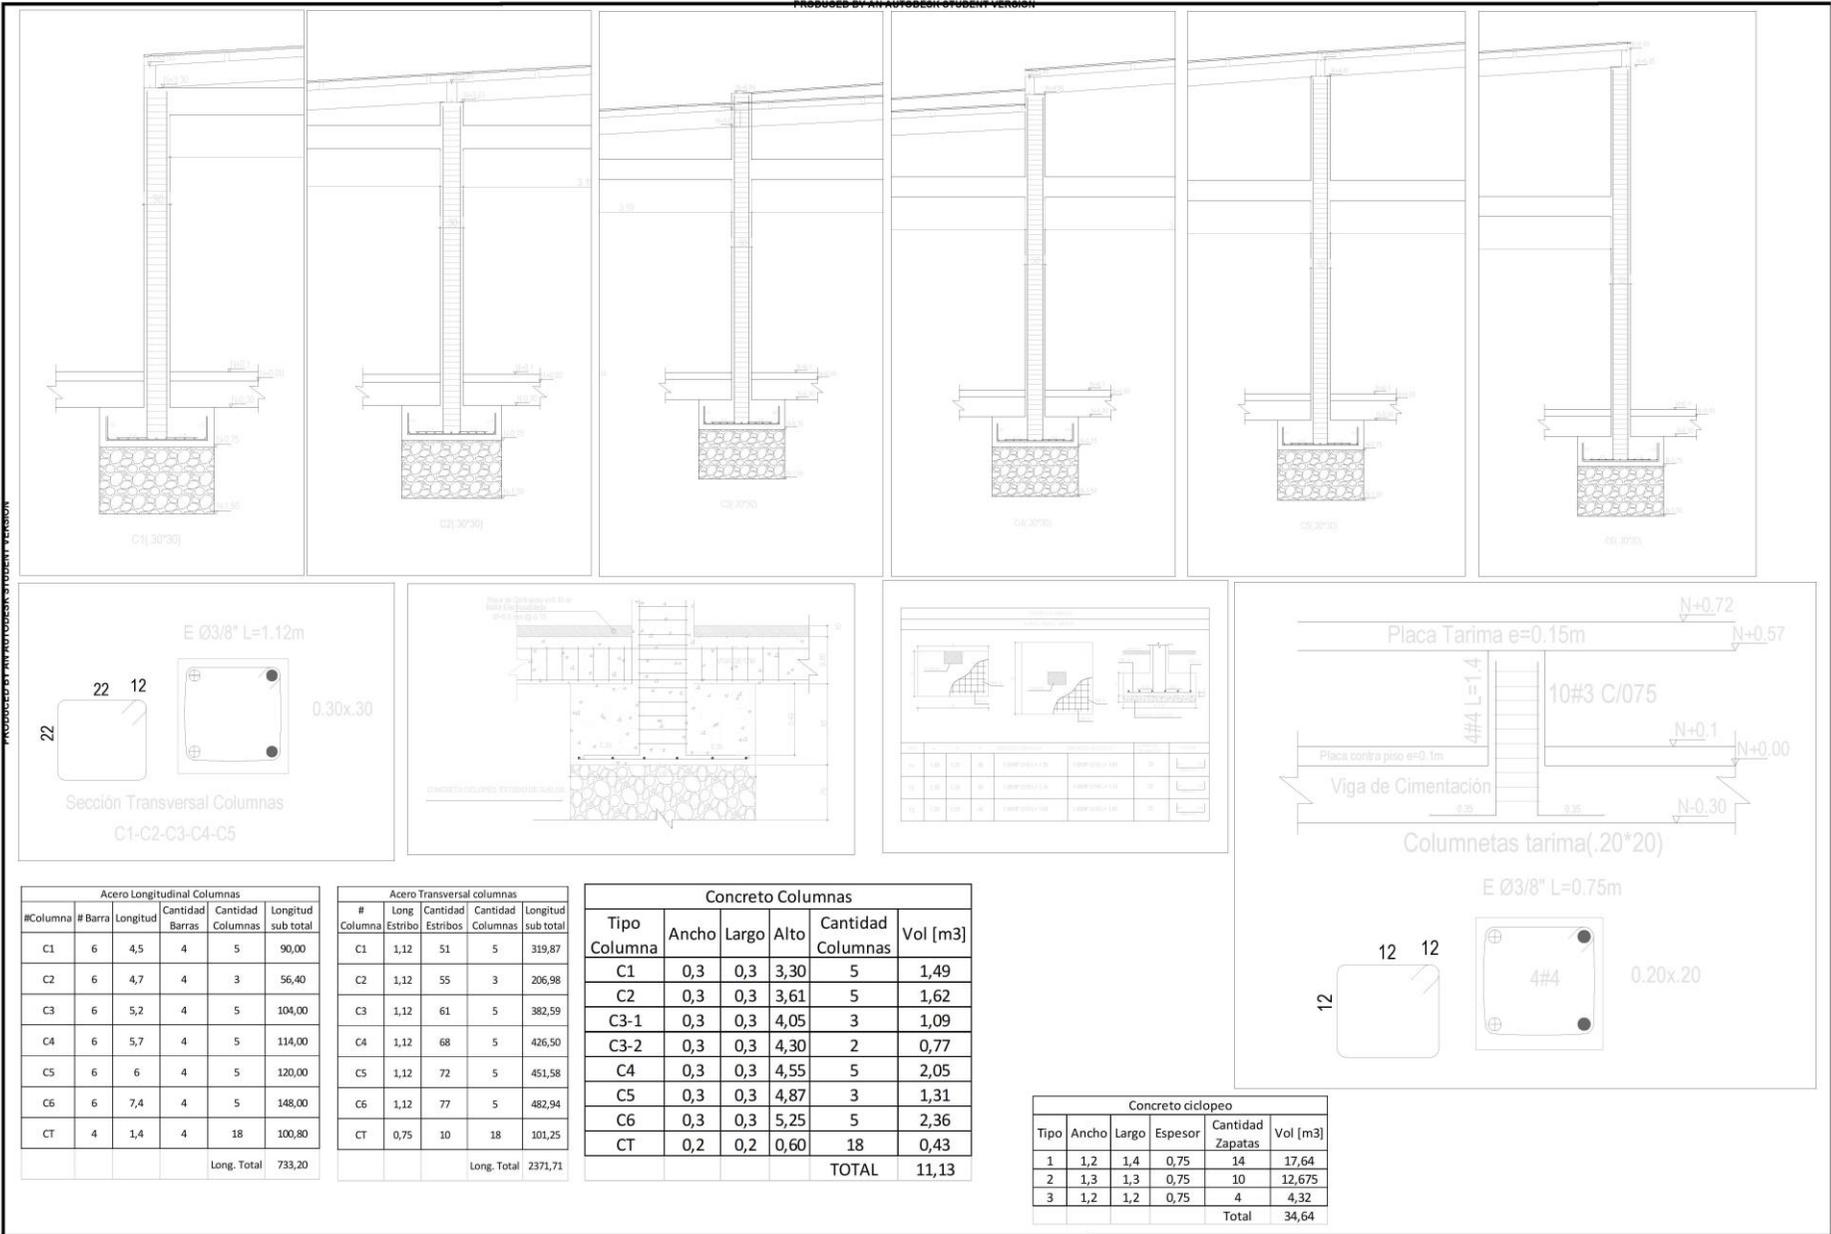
Detalles para columnas y zapatas. Fuente: UT CASA DE LA CULTURA
